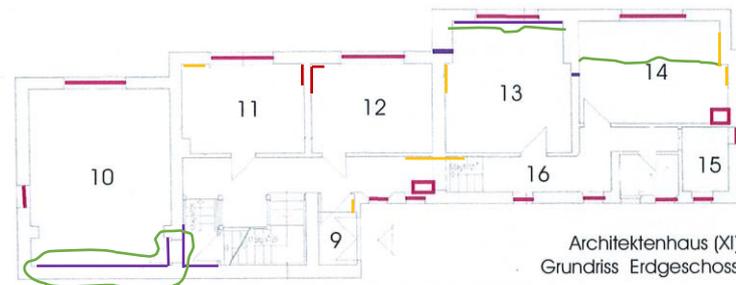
Fehlstellen im Bereich Fachwerk, Holzelemente mit geringen bis mittleren, altersbedingten Schäden
